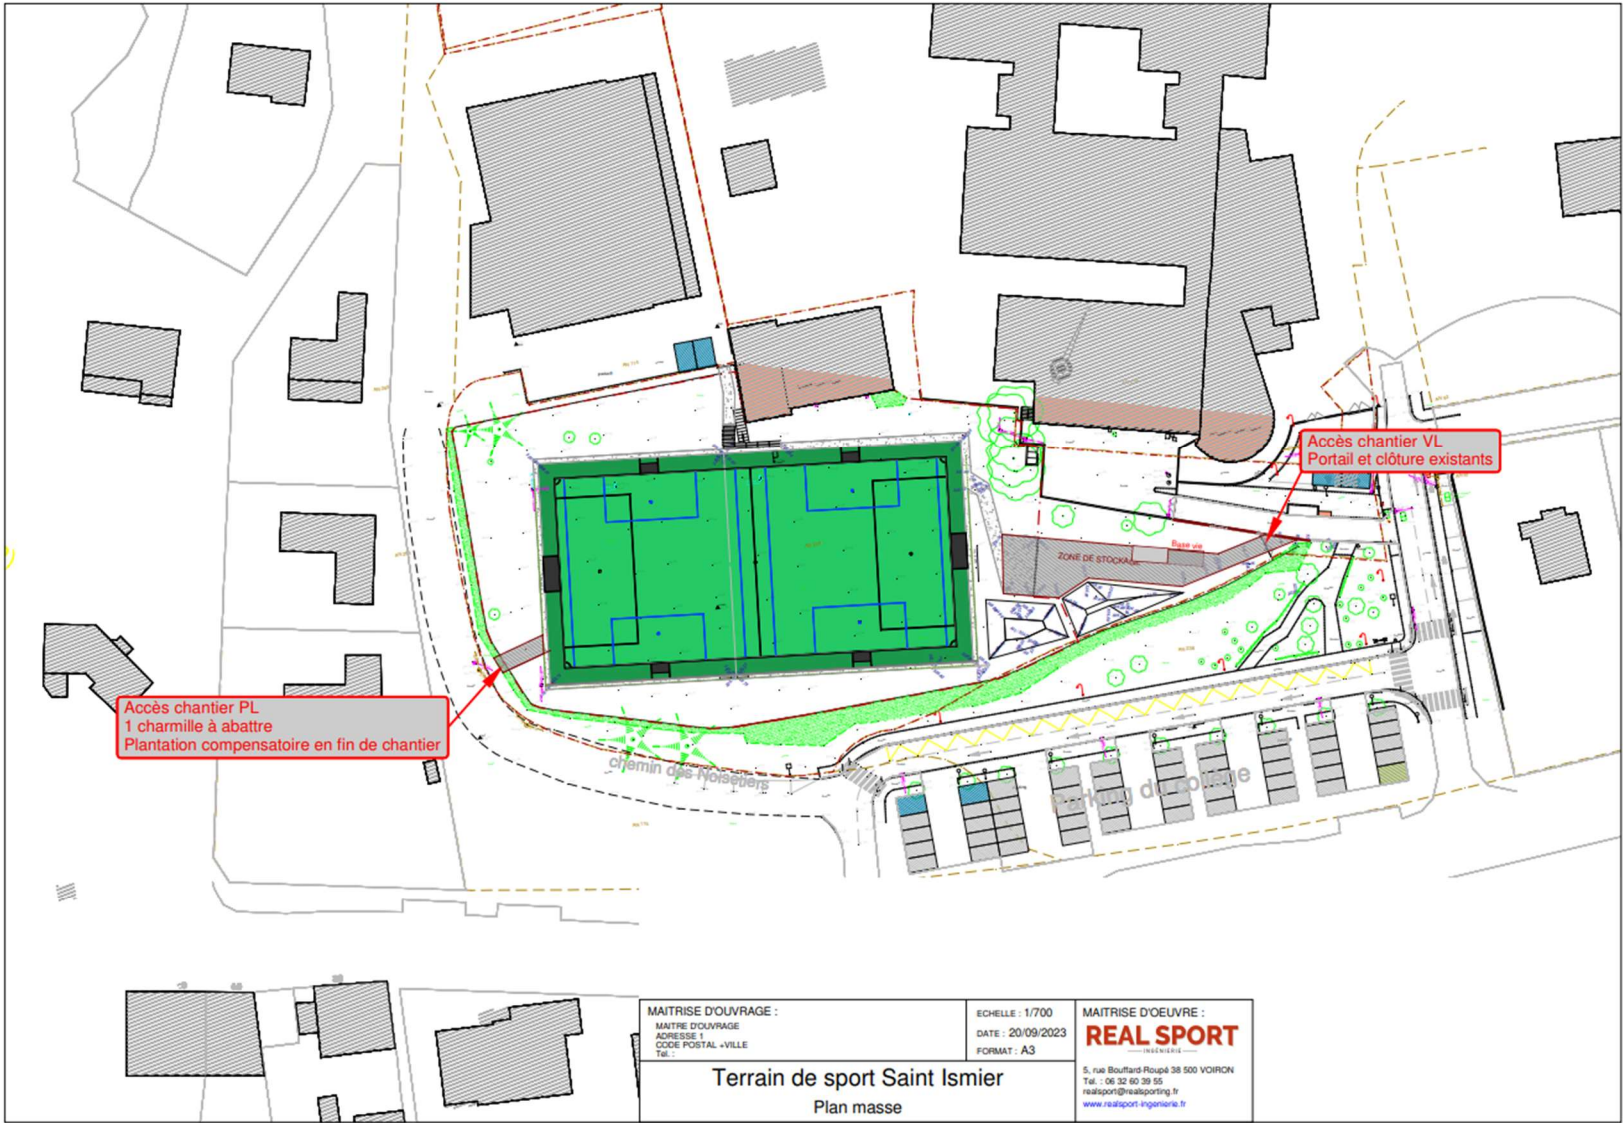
Plan des installations en phase chantier (Source : Real Sport)
